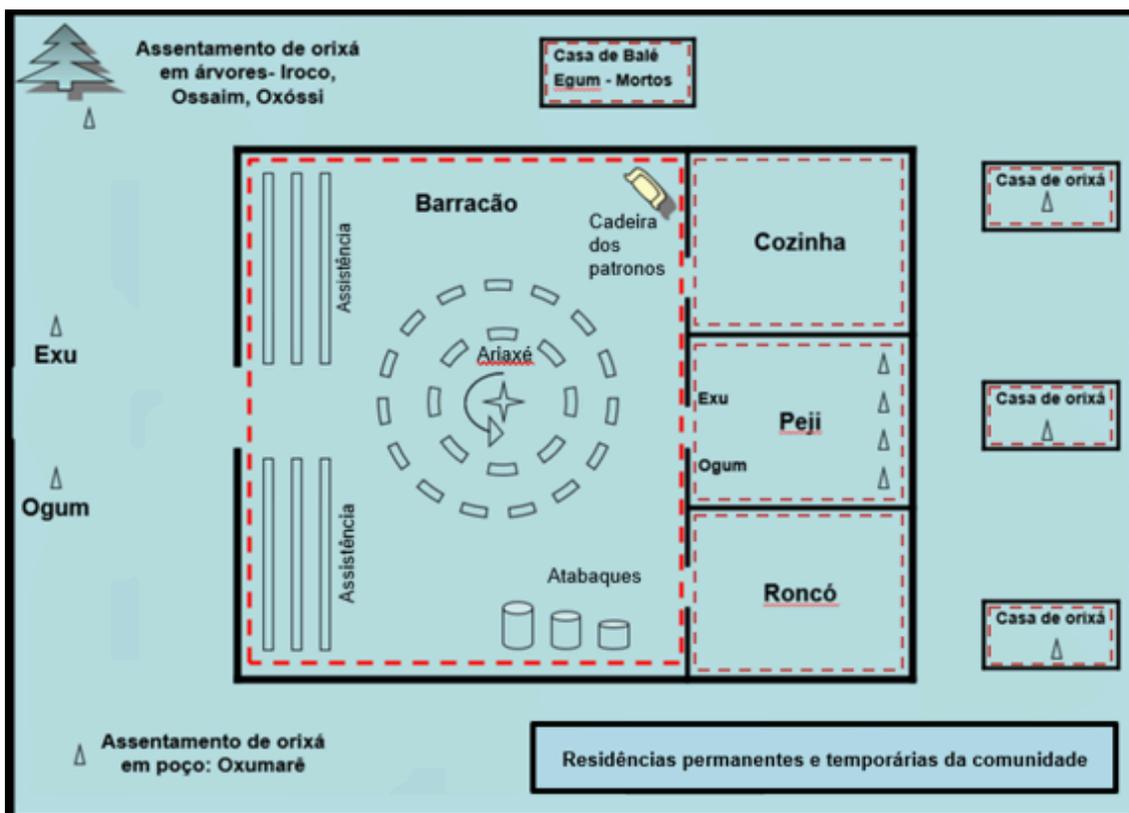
Planta baixa do terreiro. Elaboração dos autores
